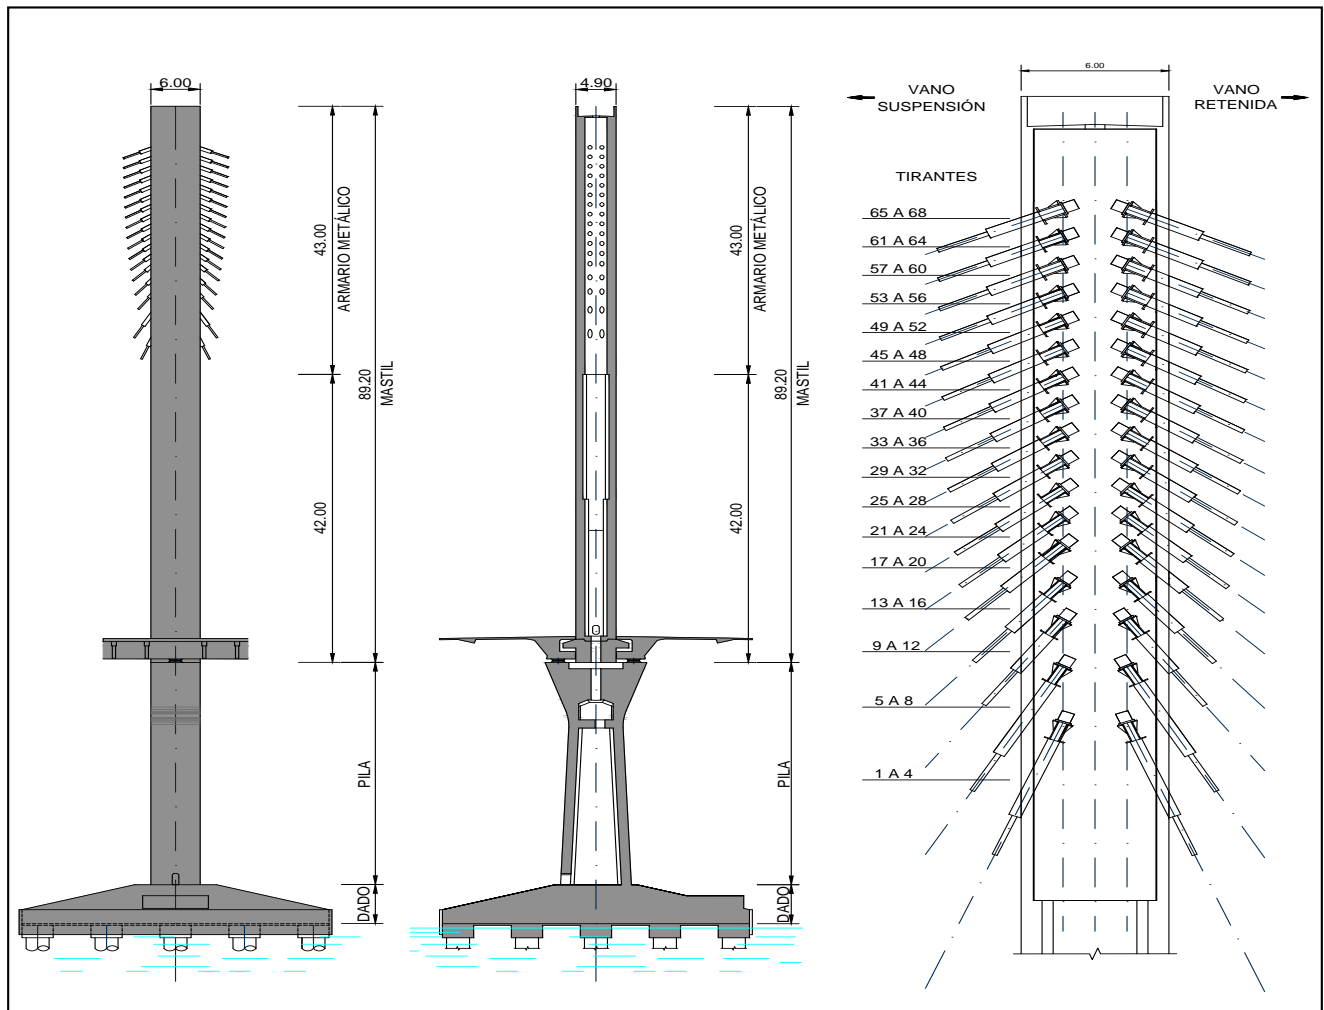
Alzado longitudinal y transversal de los pilonos, y detalle de anclaje de los tirantes mediante armario metálico.
